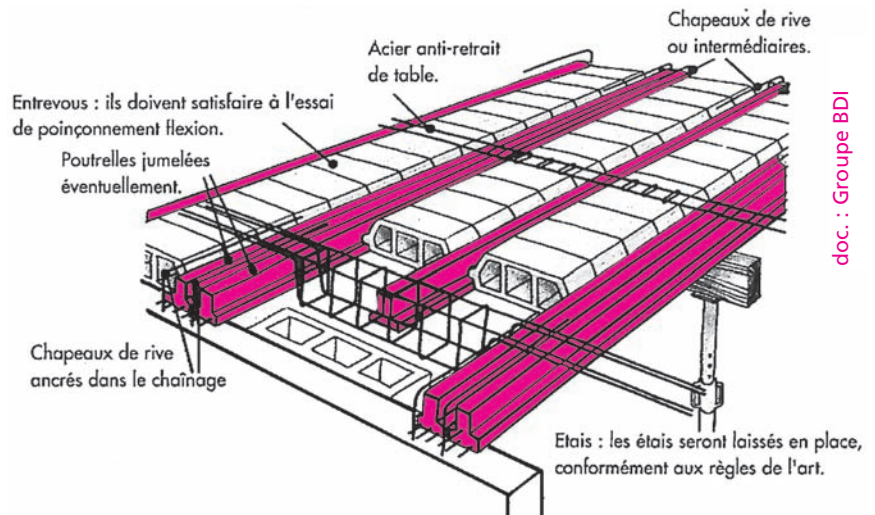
Vue du plancher avec un chevêtre pour le passage de conduits
